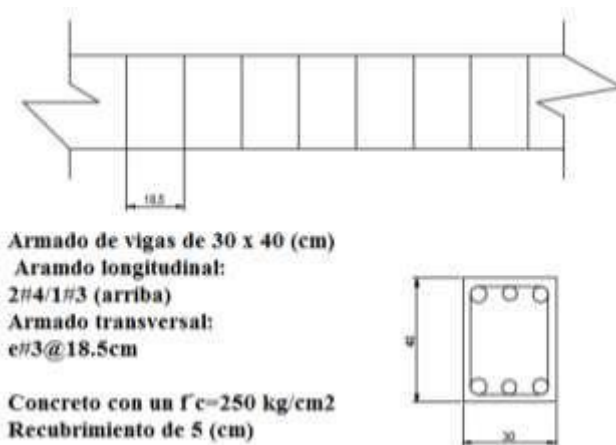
Armado de vigas correspondientes a la estructura de un nivel.
